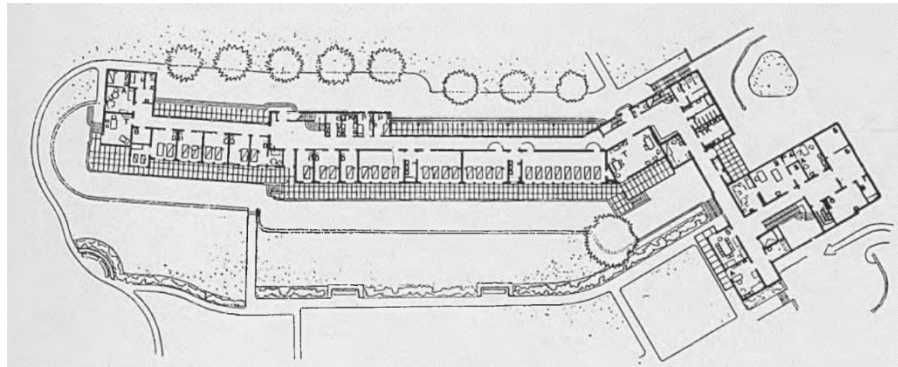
Planta del hospital de Waiblingen de Richard Döcker.
